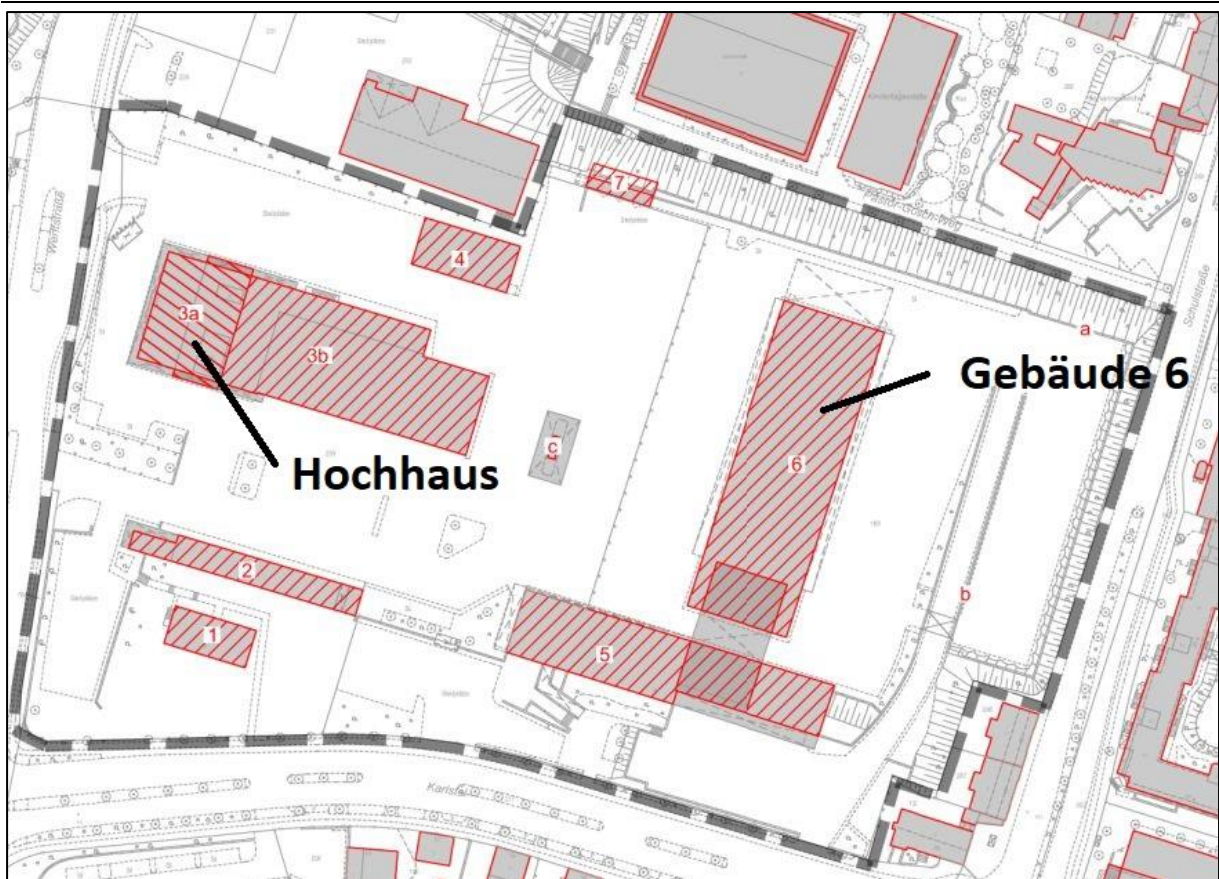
Lage der Möwenkolonien auf dem Hochhaus und dem Gebäude Nr. 6
